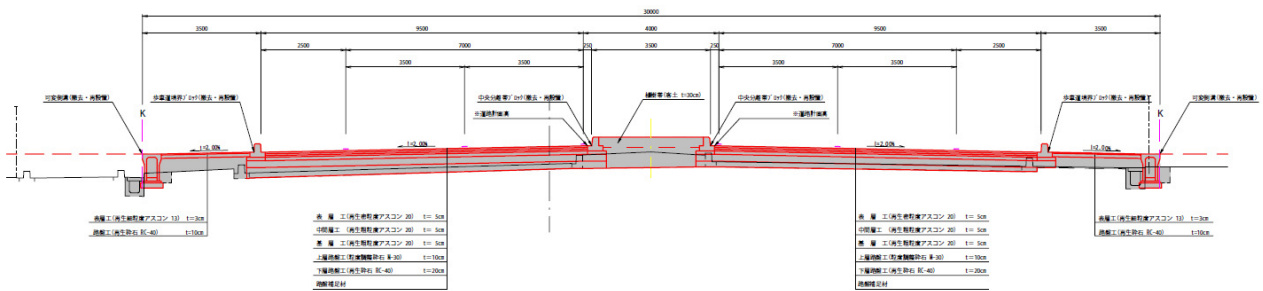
No.8 常陸那珂港区\_臨港道路4号線の断面図(復旧後)
